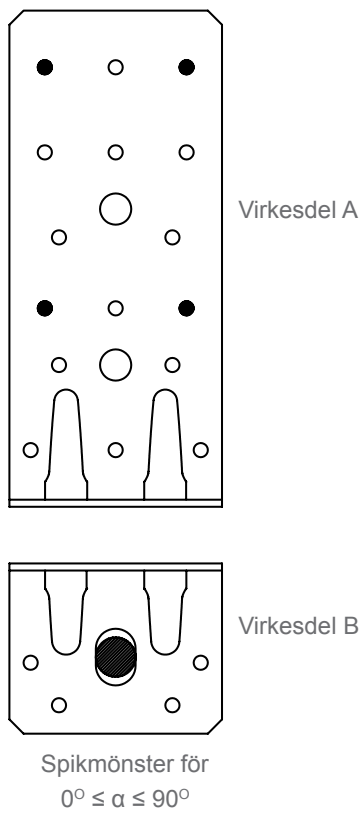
Spikmönster vid bultinfästning till betong, beslag 4230101.
